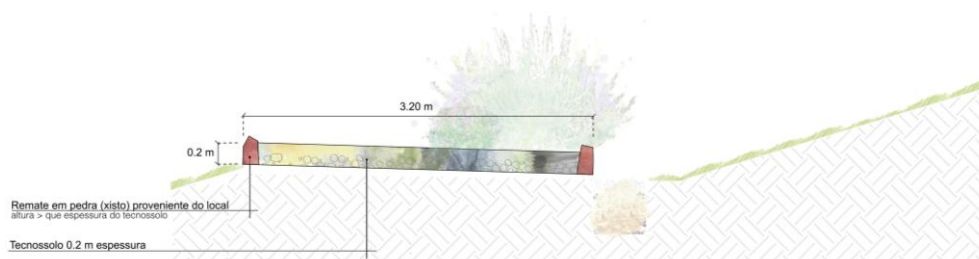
Pormenor construtivo (sem escala) do Tecno solo a aplicar.
